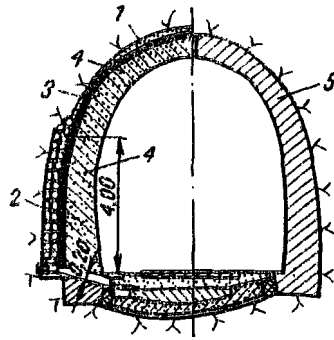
Дренаж и гидроизоляция обделки туннеля, [Л. 30]:
